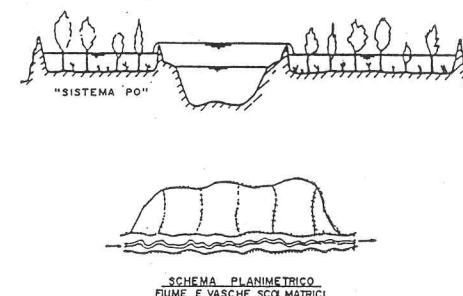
(da Jansen et al., 1975) "Sistema Po": Schema planimetrico e sezione tipo.
